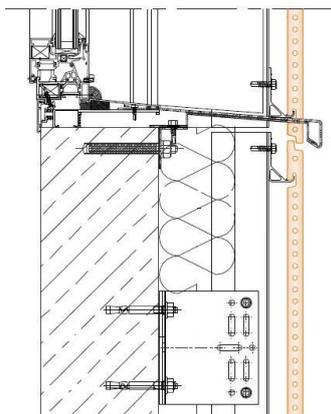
Alféizar. FAVEKER® FV. Sistema perfil horizontal.
